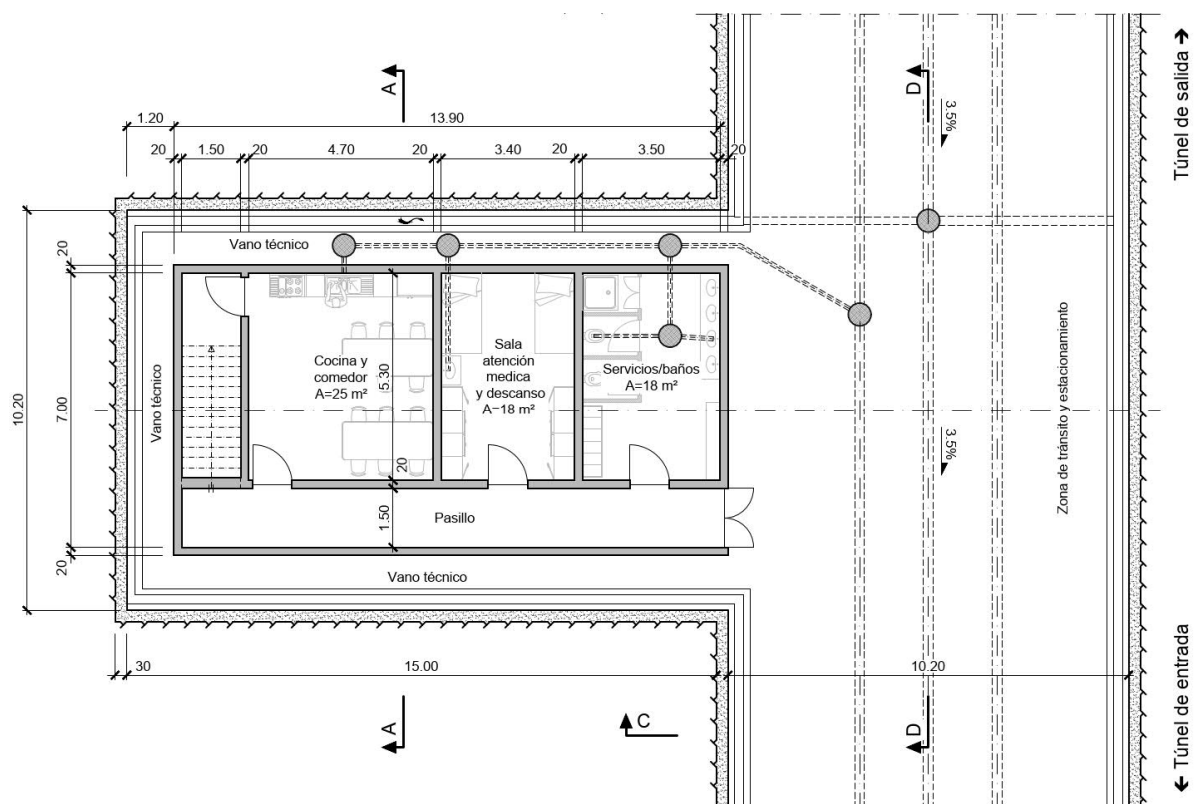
Planimetría planta baja: servicios, sala de emergencia y comedor
